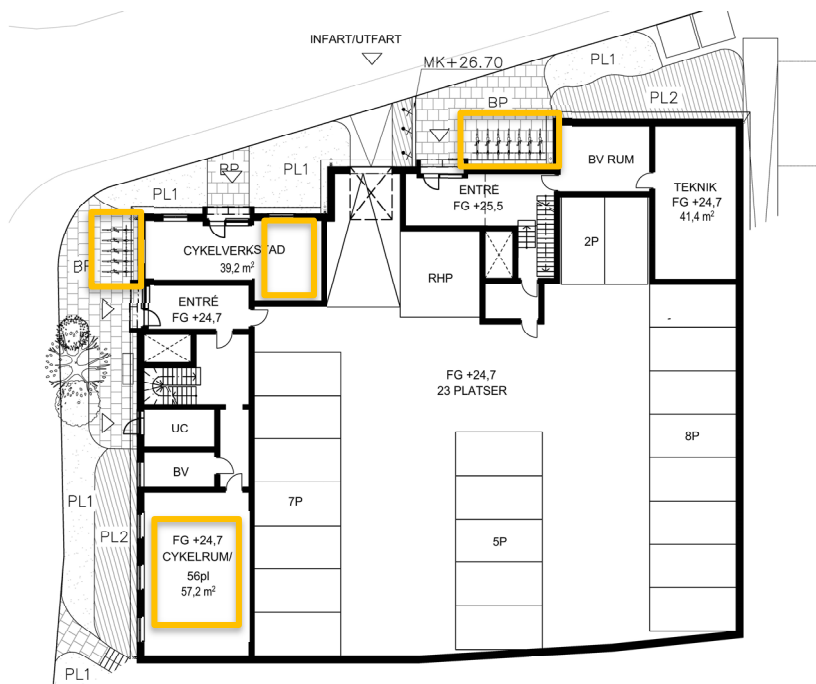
Cykelparkering anordnas i cykelrum på garageplan med 56 platser och besöksparkeringar. På garageplan finns även den planerade cykelverkstaden.
